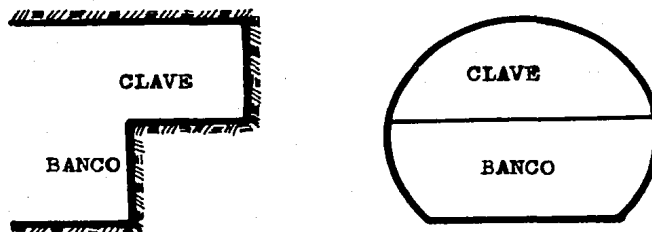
; partes en que se divide la sección del túnel para realizar los trabajos de excavación.
